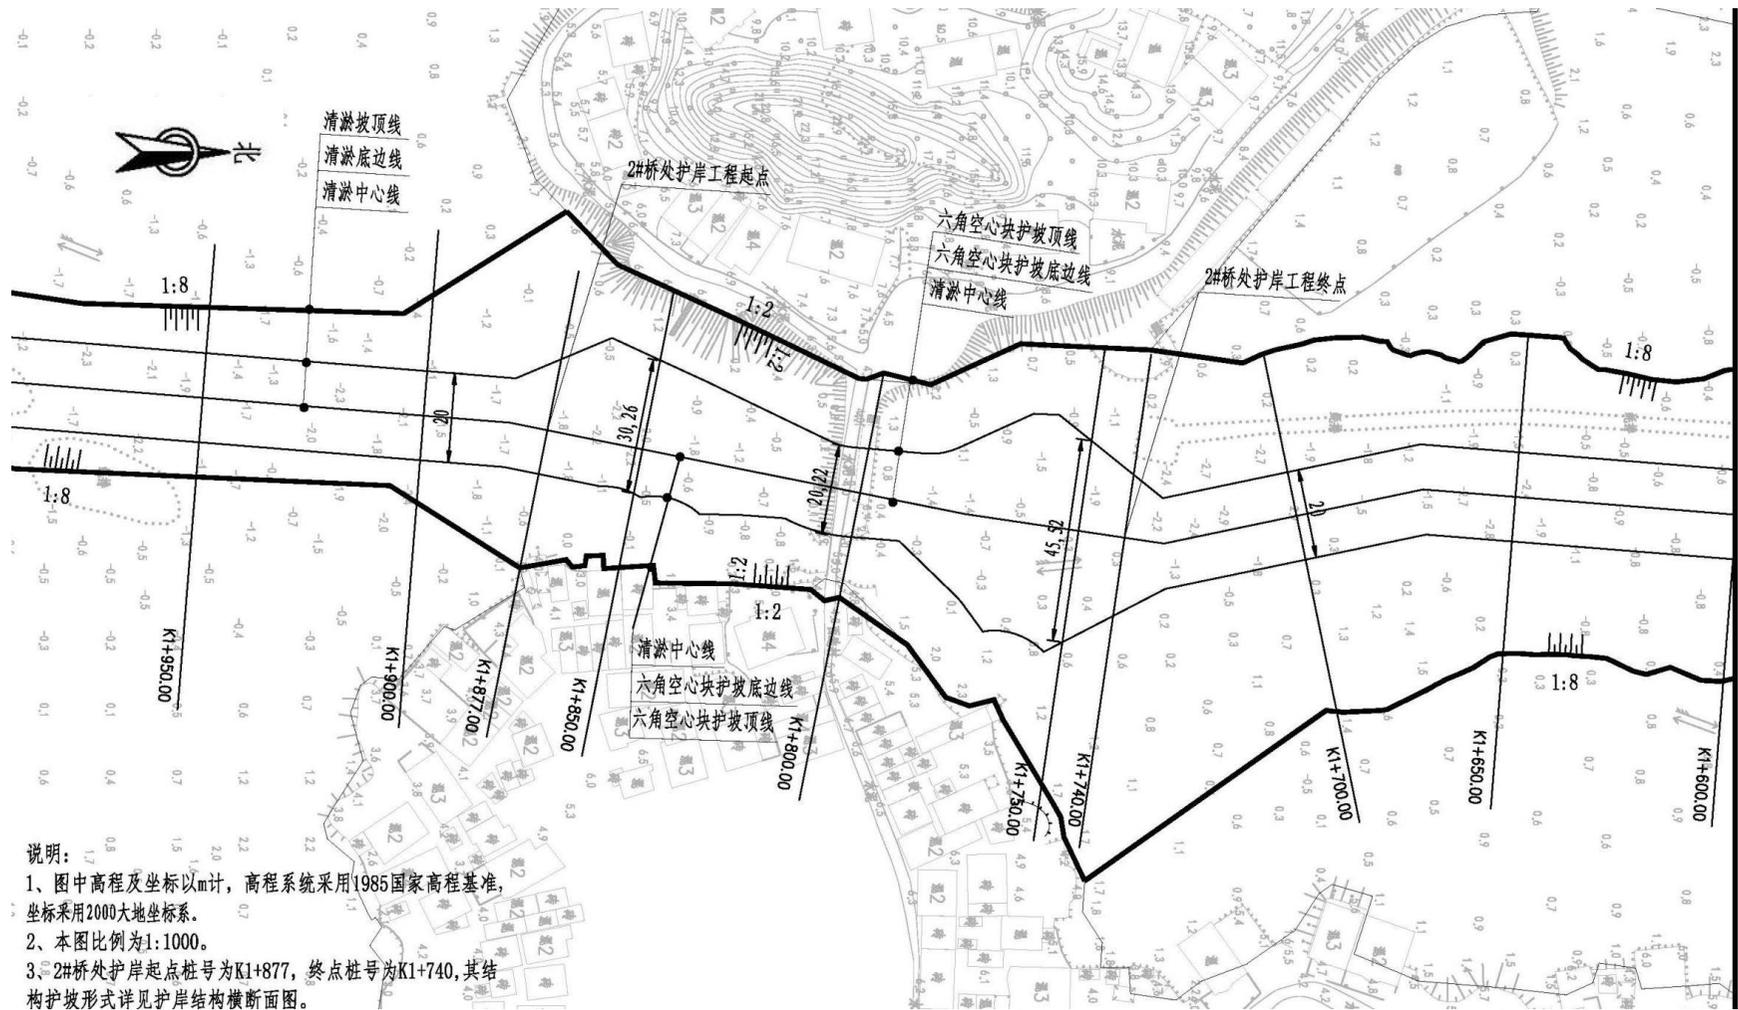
岸线生态整治平面布置图（2#桥处护岸）
